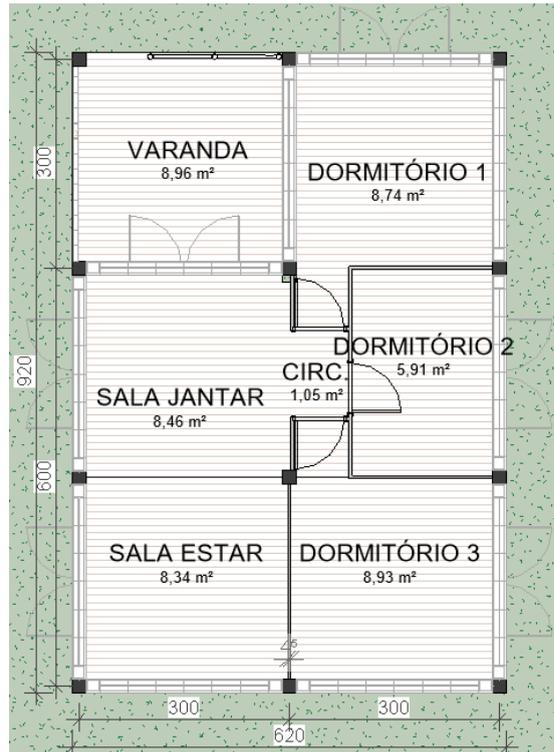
Planta baixa do abrigo. Fonte: Elaborado pelas autoras (2025).
